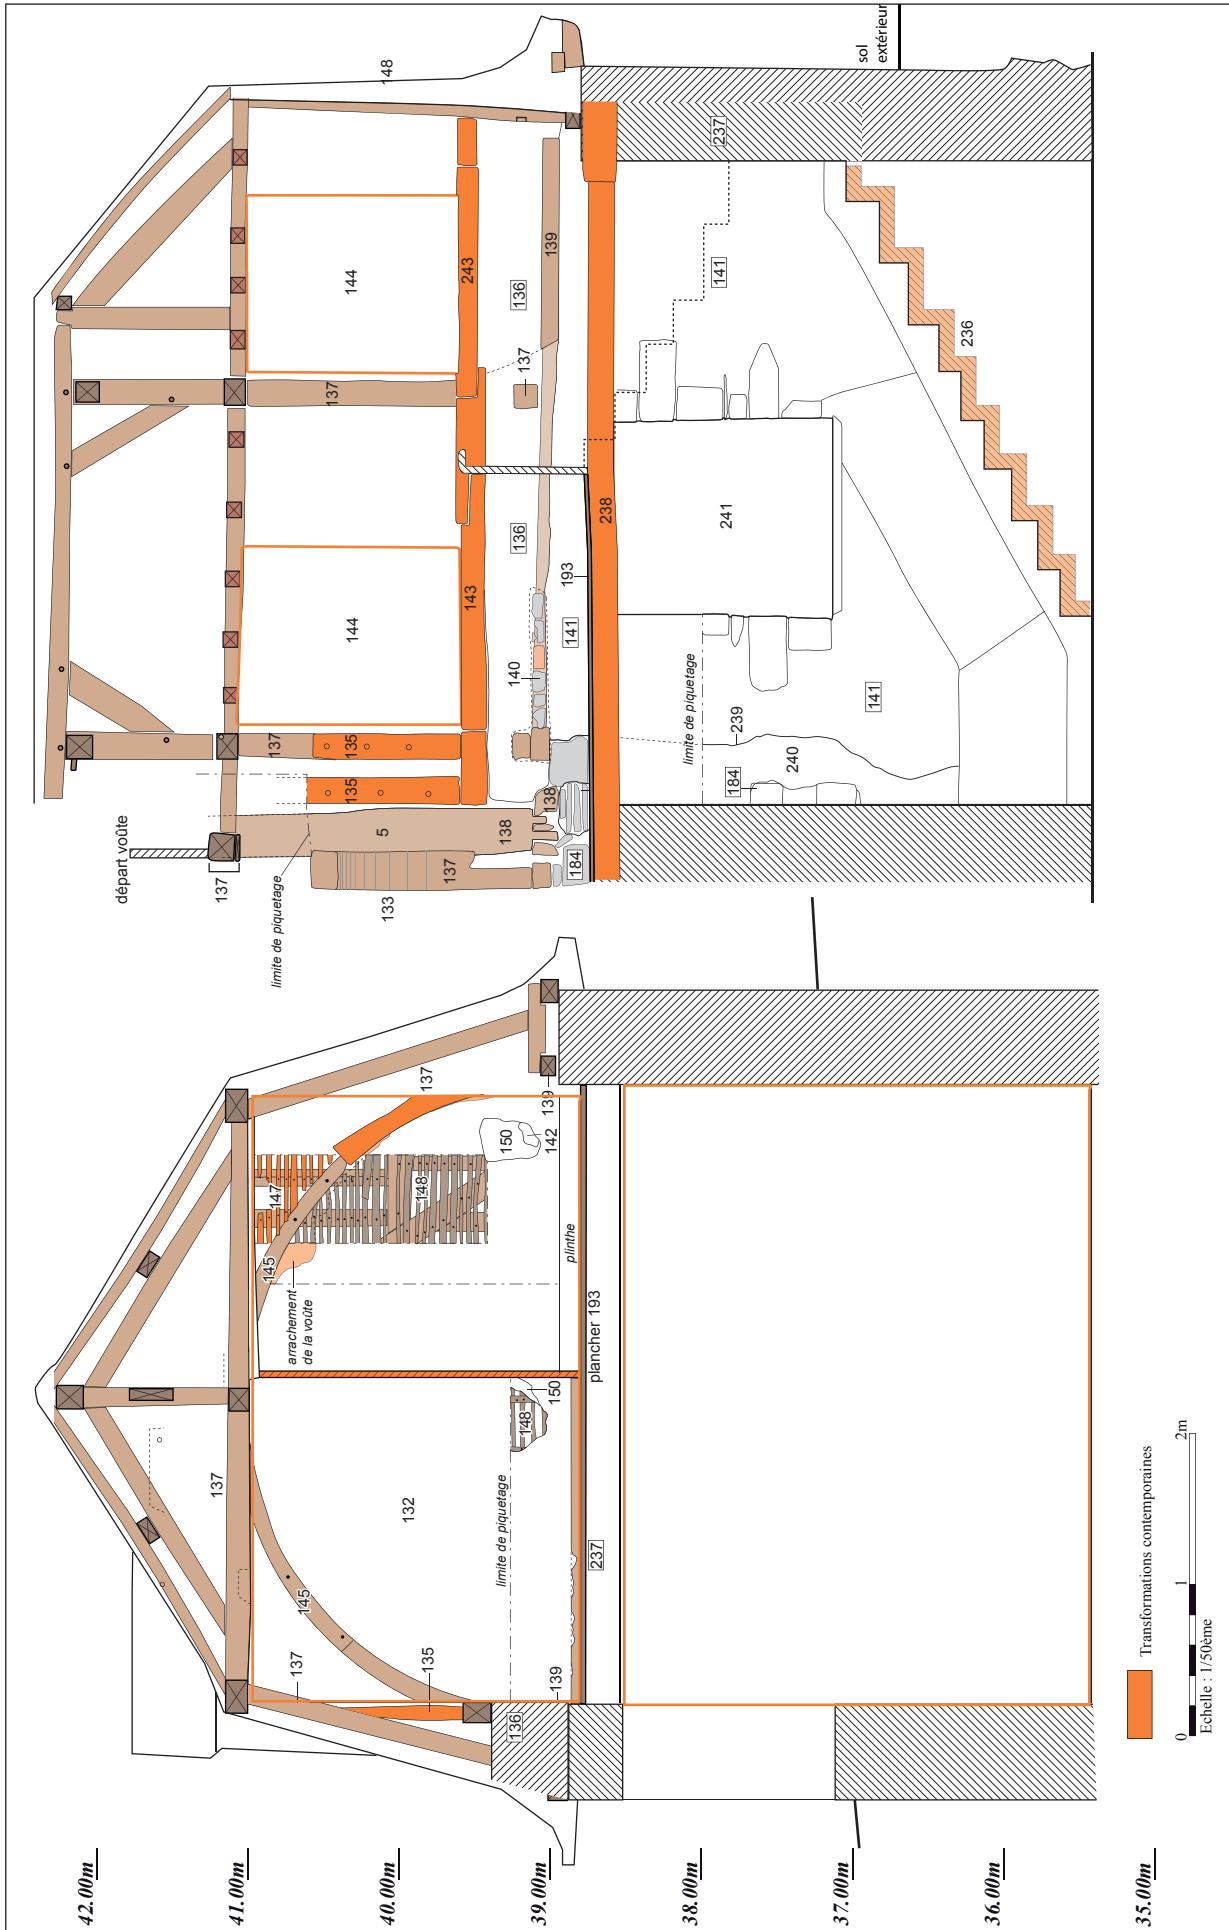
La coupe transversale sur la chapelle latérale © Arnaud Desfonds, Elen Esnault, Inrap
